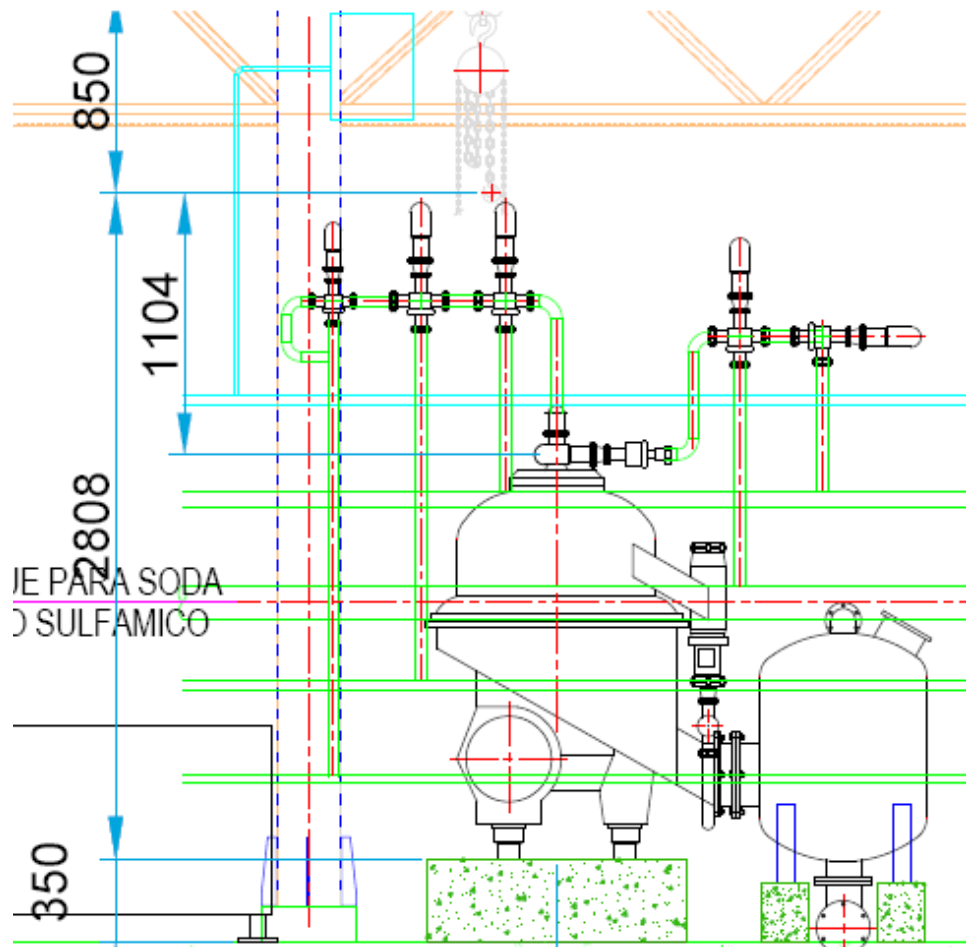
Planos de Instalación de las Maquinas Centrifugas
